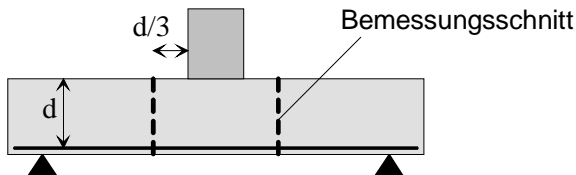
Lage des Bemessungsschnittes bei gedrunenen Platten
